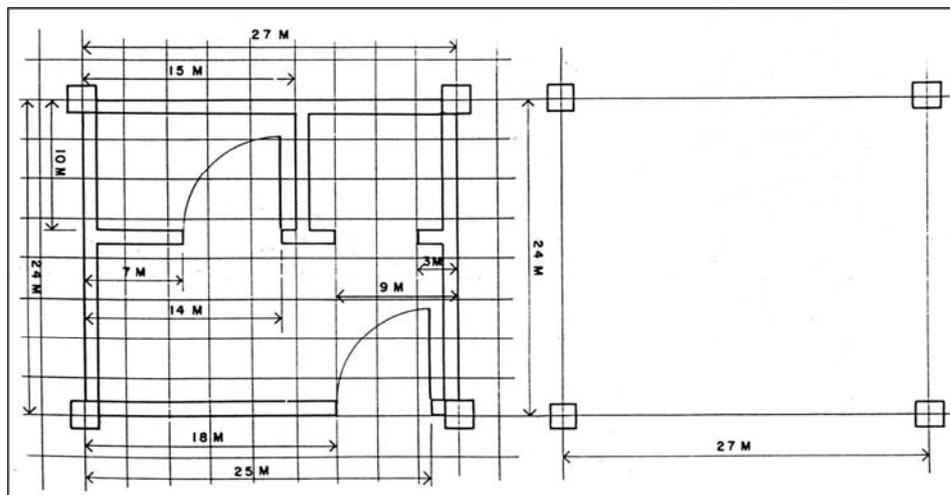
Desenho de componentes modulados – Quadrado modular de referência.
